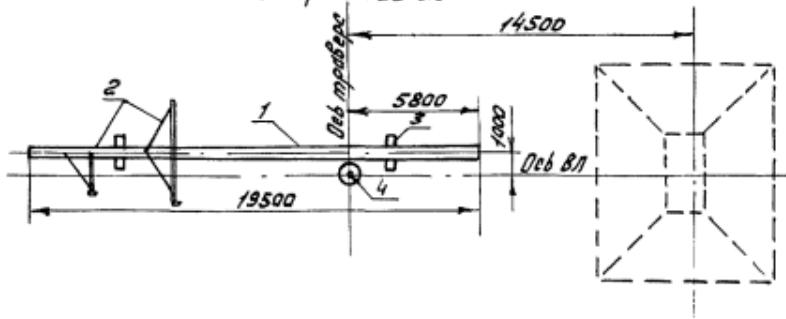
Схема выкладки и сборки опор: УБ 110-1; КБЗ5-110-1
